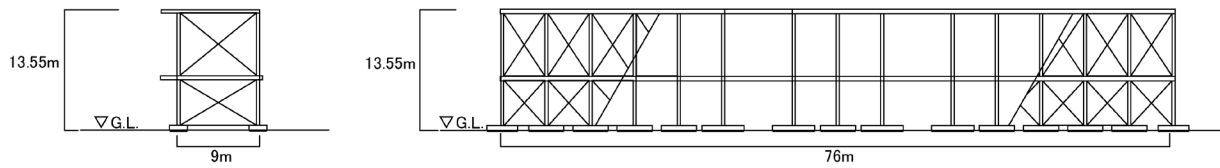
(4) 断面図 (E 設備架台、G 設備架台)
